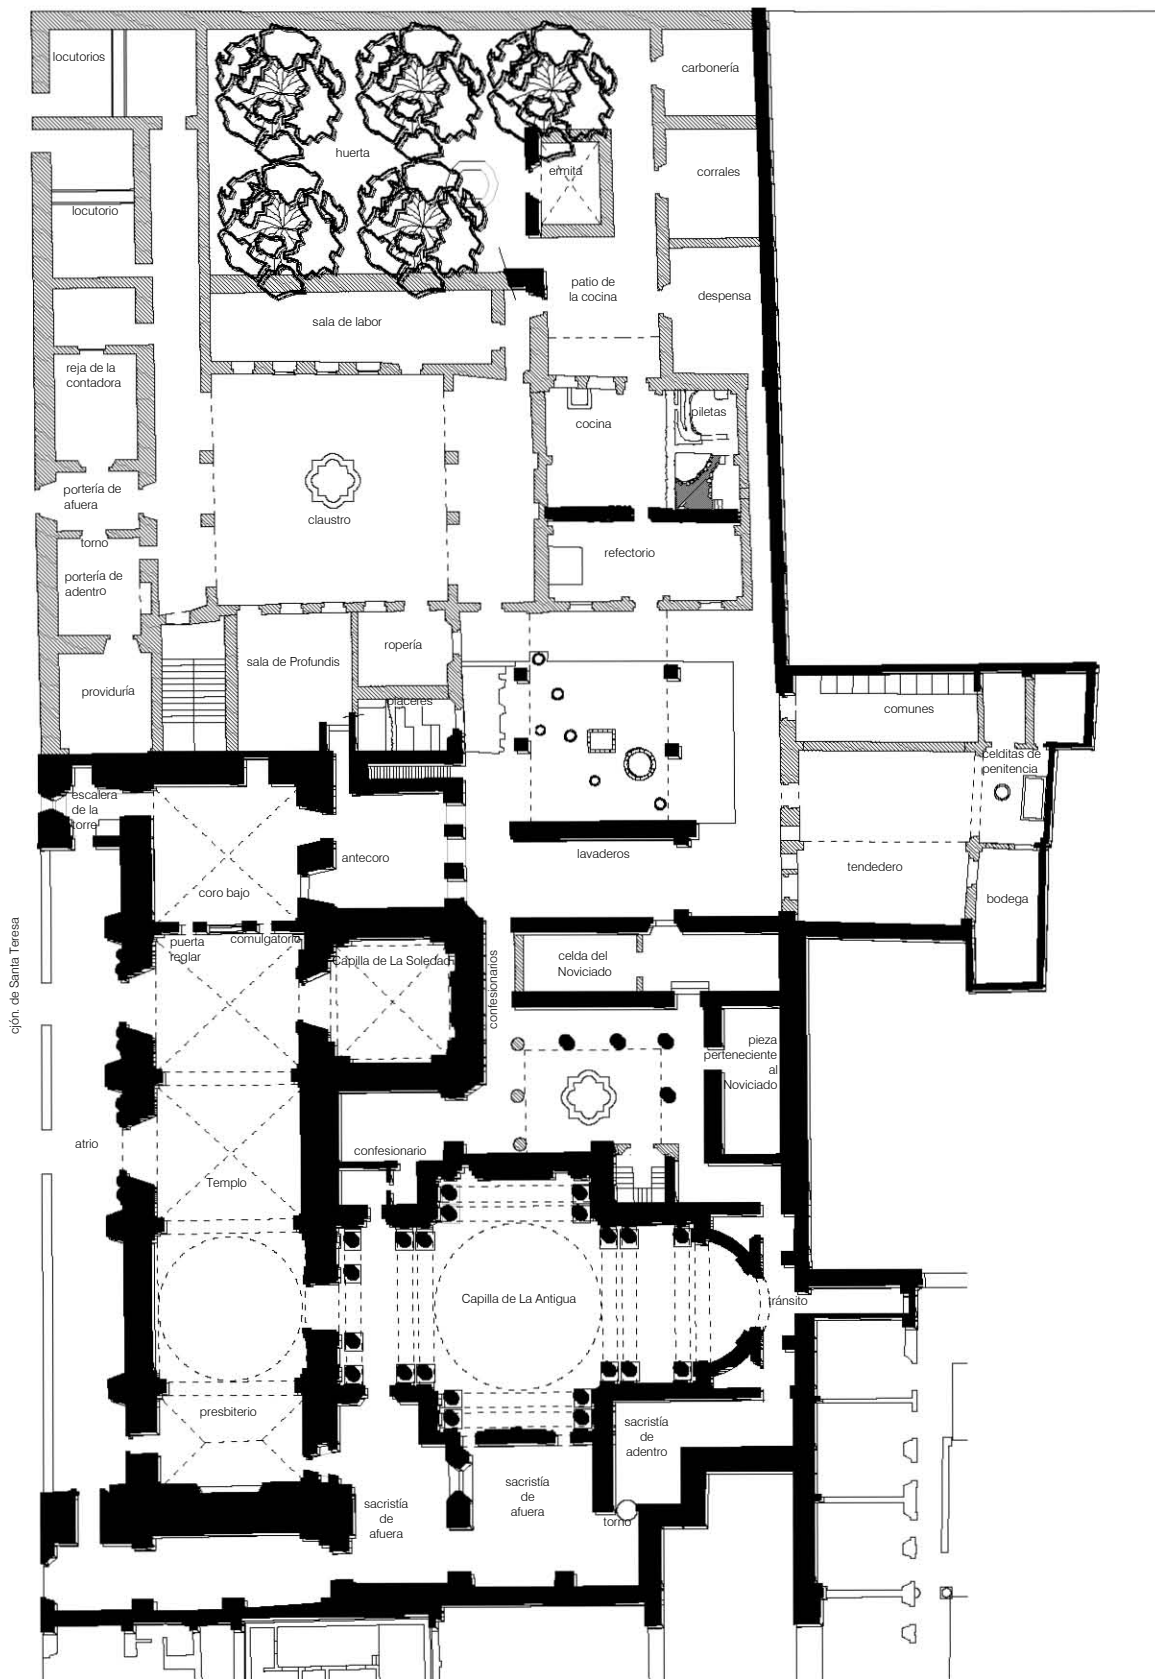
Planta baja del Convento de San José hacia el siglo XIX. Reconstrucción hipotética del autor, 2017.
